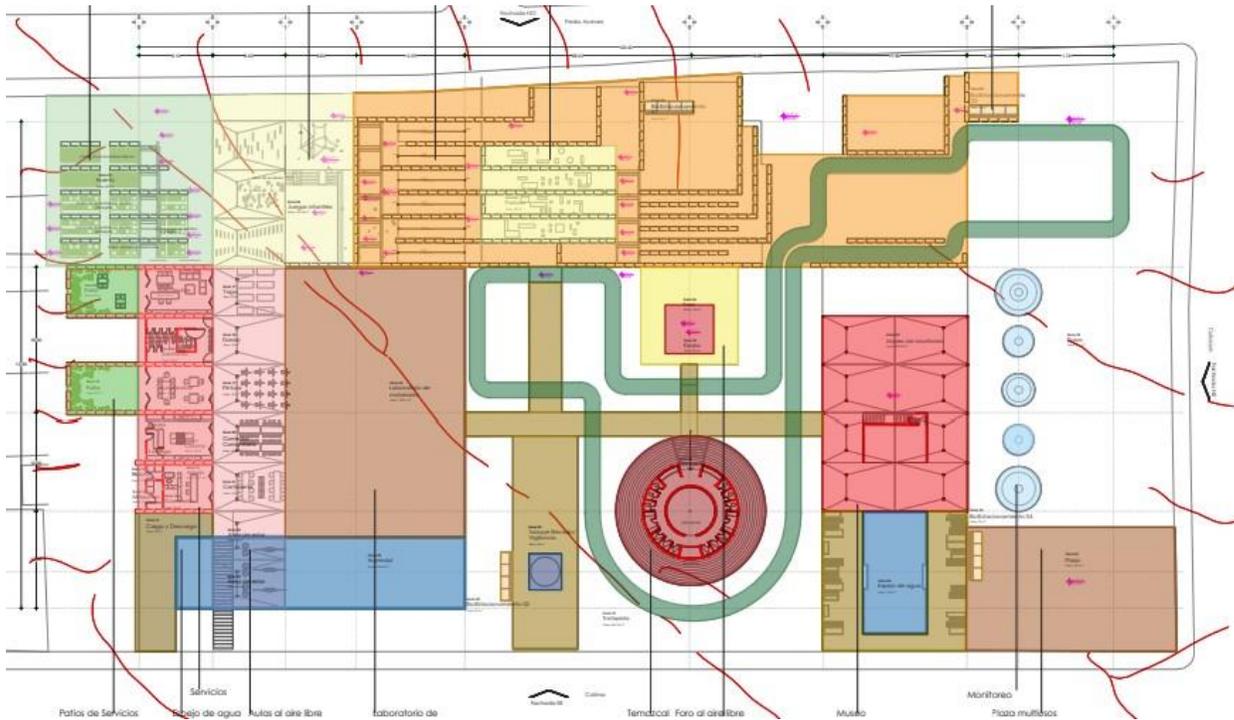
Planta arquitectónica de conjunto. Anteproyecto para la UTOPIA Tecoloxtitla.
